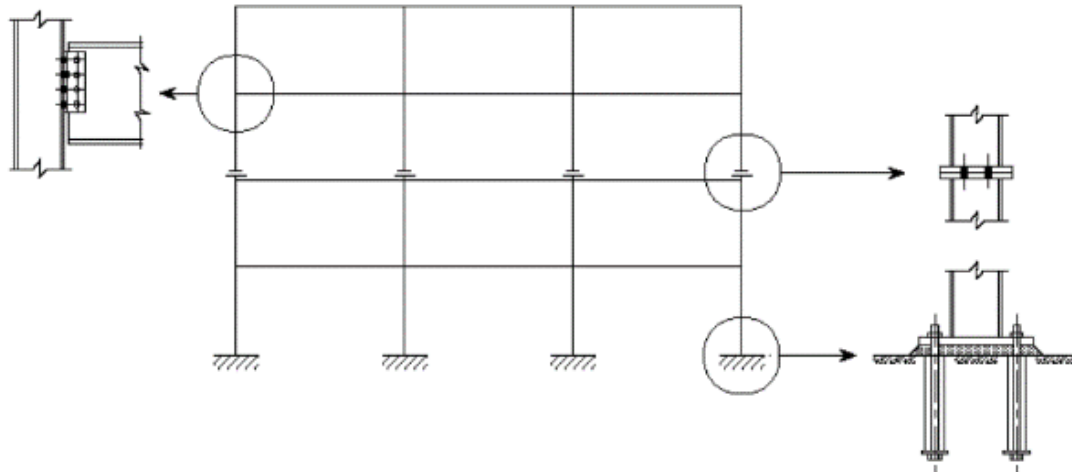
Principais tipos de ligações em estruturas metálicas segundo (Martins, Estruturas Metálicas - EC3 (versão 1993) - Ligações, 2011)
